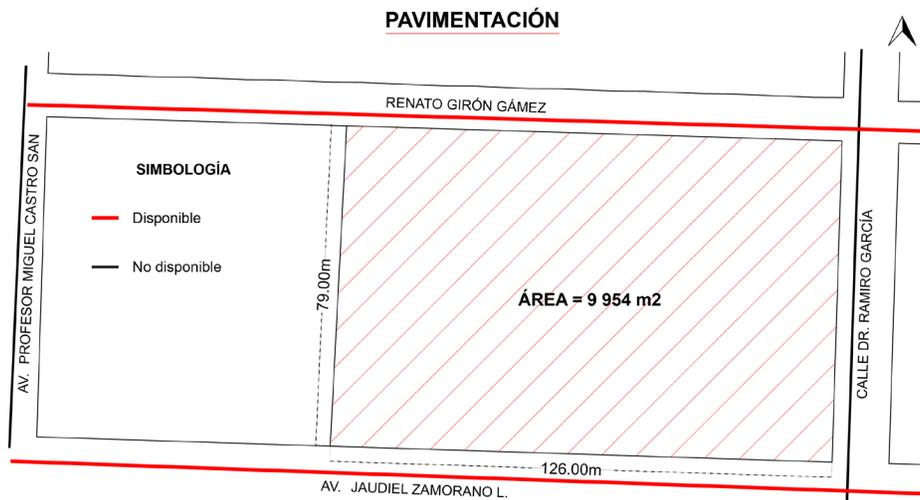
Pavimentación en las calles. Autoría propia, 2019.
